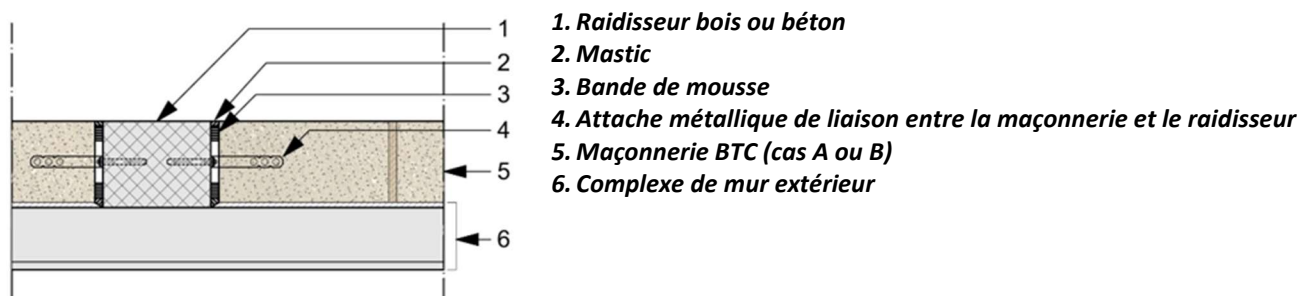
Détail en plan de la liaison entre maçonnerie et raidisseur par attaches ponctuelles (cas A ou B)
